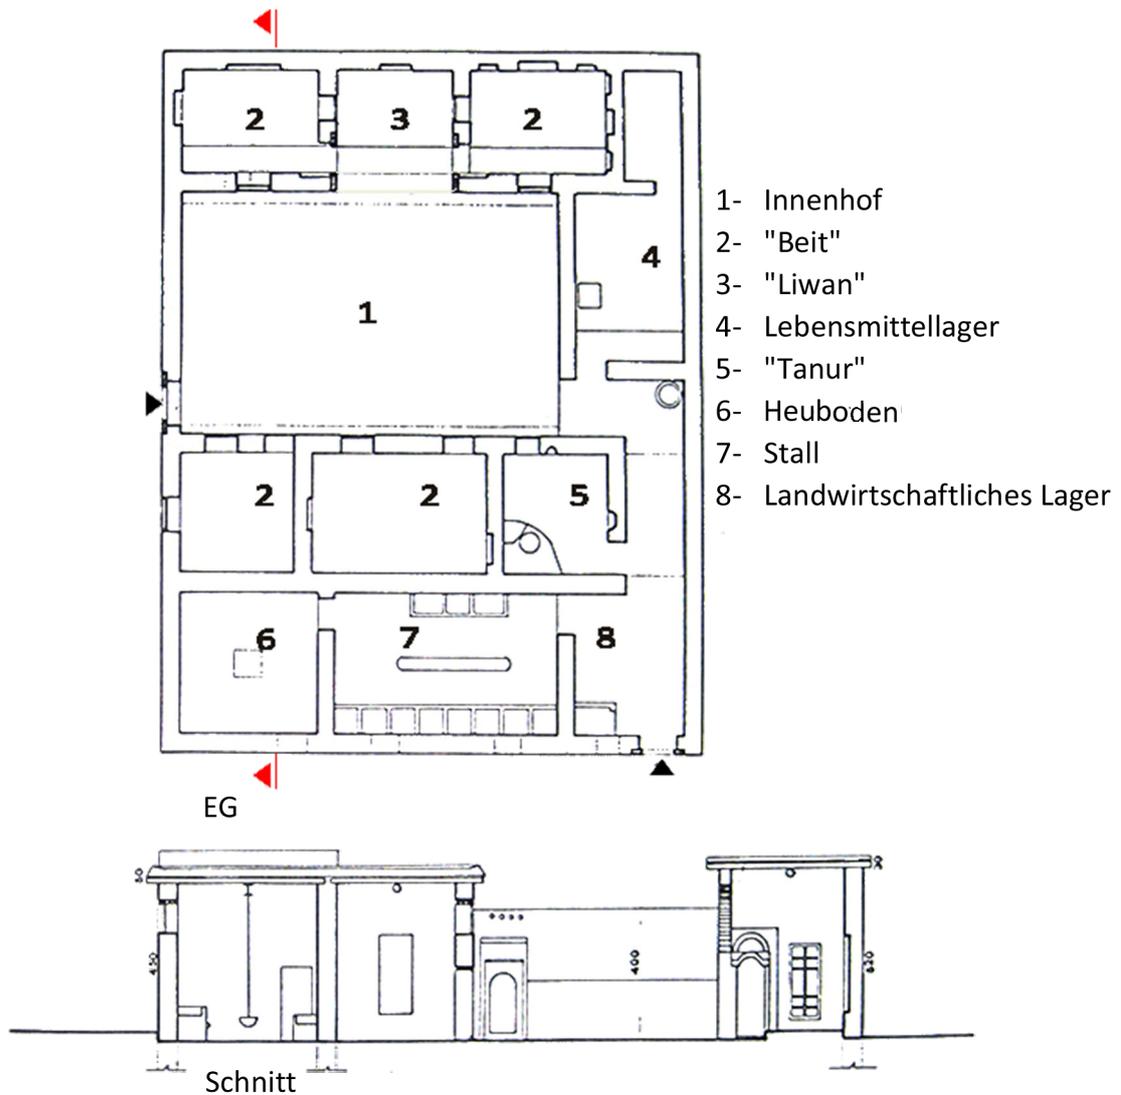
Abdelrahman Alcholi Haus in Misrabah in der Gegend Alghutah- Grundriss & Schnitt M:1/200
